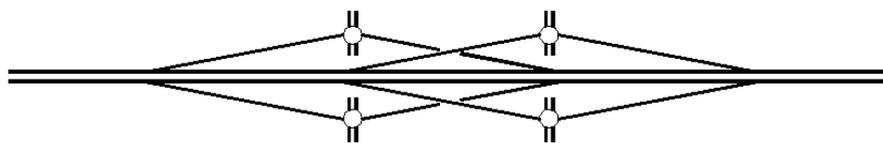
Схема планировочного решения с перекрещивающимися рампами
